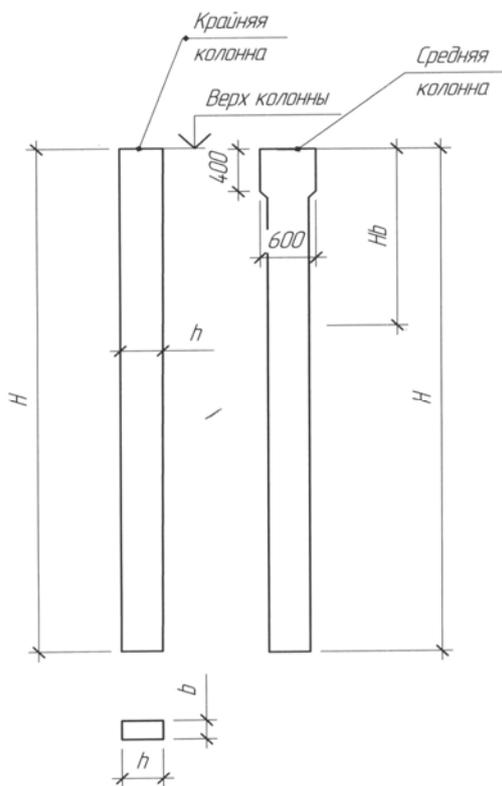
Конструкция колонн для зданий без мостовых кранов
